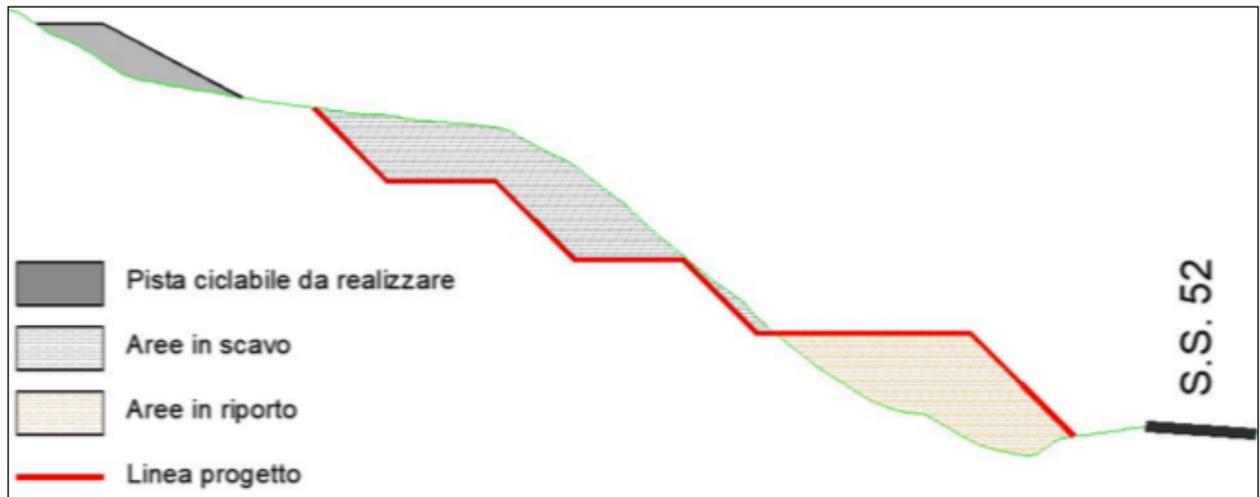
Progetto di fattibilità - Sezione tipo movimentazione materiali
